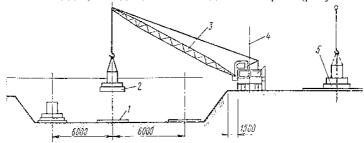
Монтаж опалубочных блоков фундаментов:
